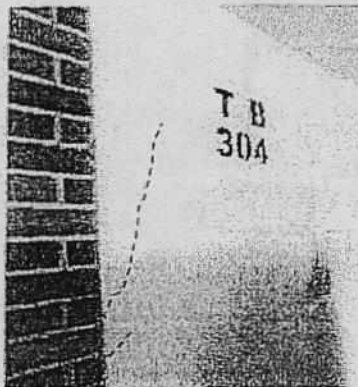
Fisura en muros de cerramiento torre costado norte.
